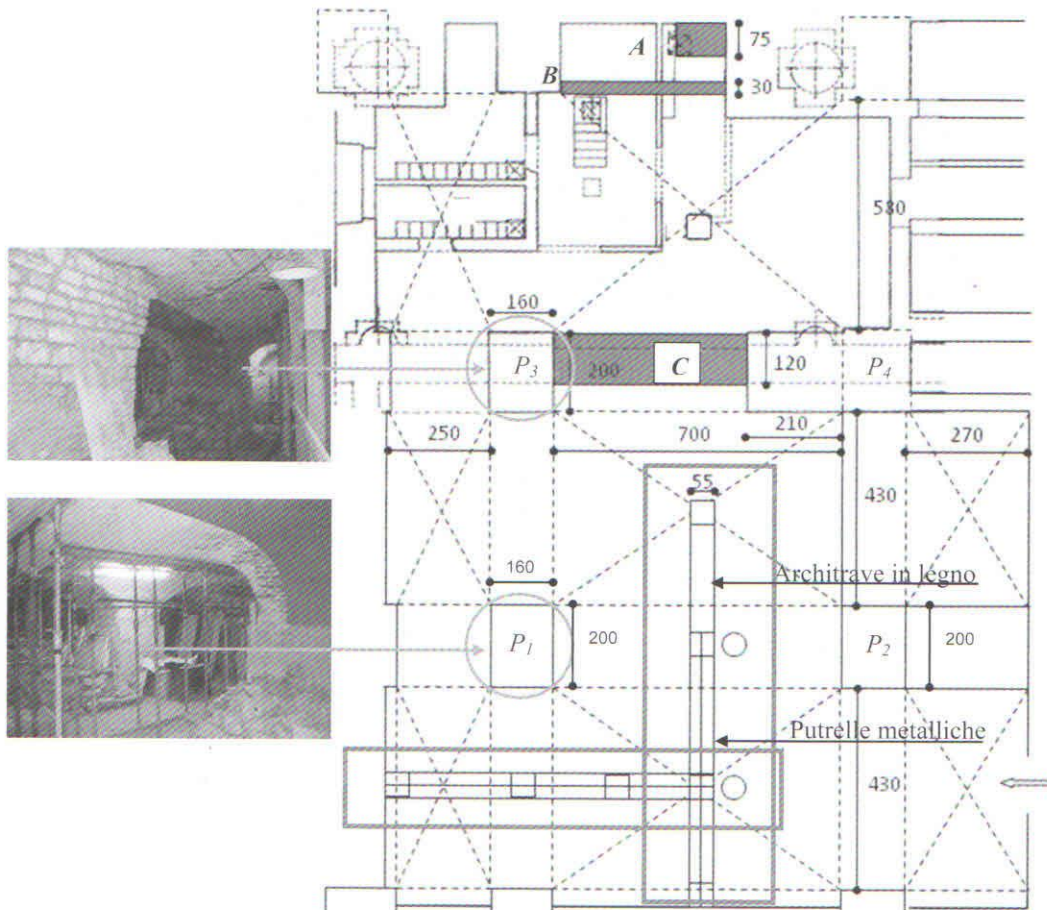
Pianta della cripta e vista fotografica dei pilastri P_1 e P_3 allo stato attuale
